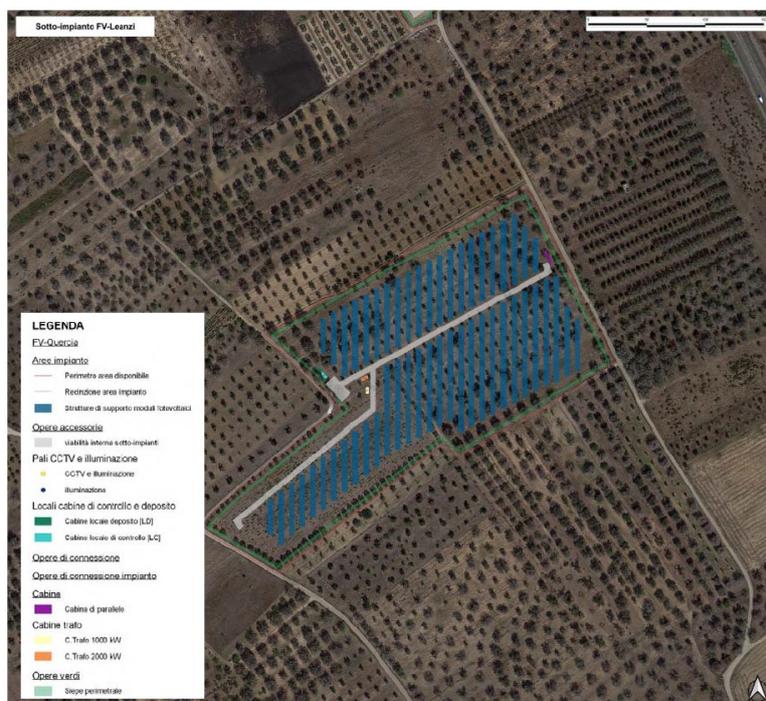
Ortofoto sotto-impianto FV-Leanzi.
